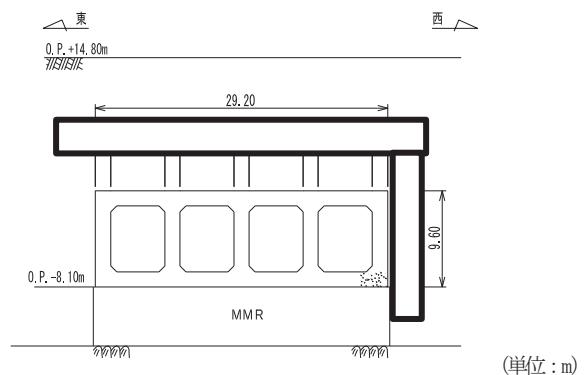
取水路（漸拡部）断面図（D-D 断面：断面③）
